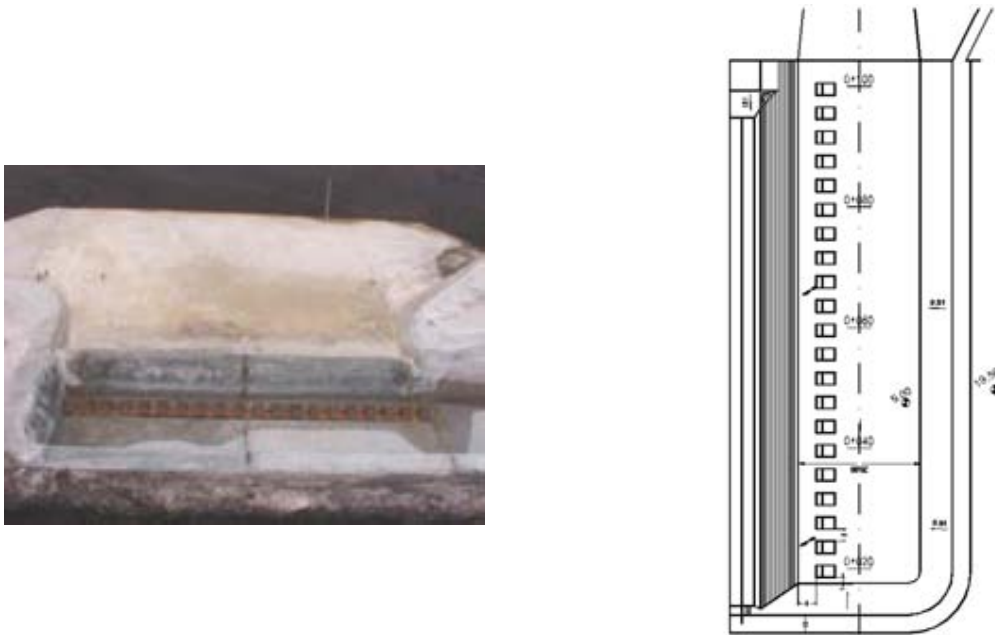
Vista en planta de las dimensiones finales del canal colector
